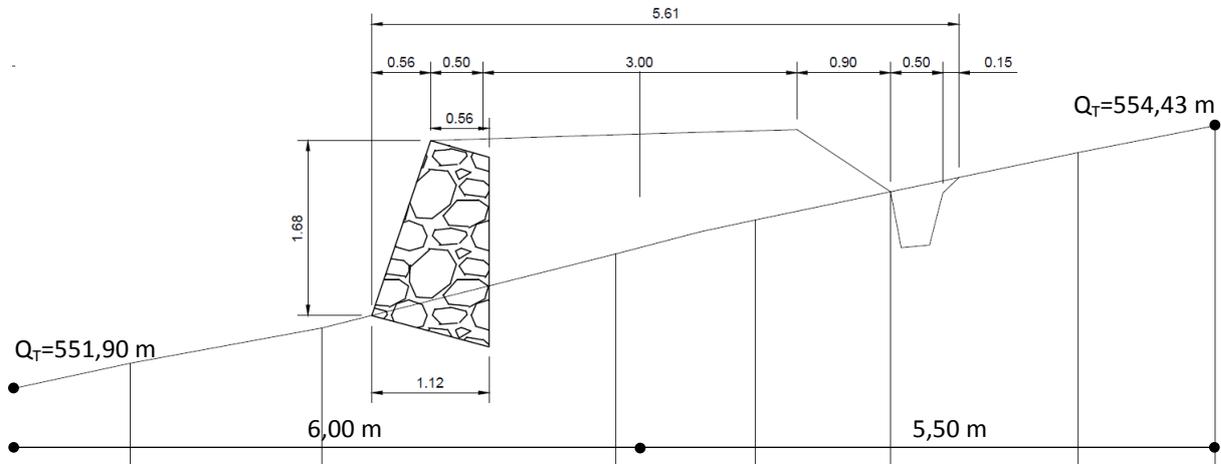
Calcolo dell'UCS_n nella sezione pista 23bis_a
